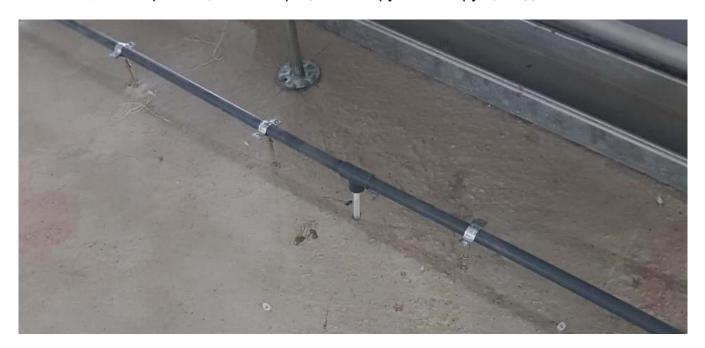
, Пример размещения аспирационных труб в конструкции здания
